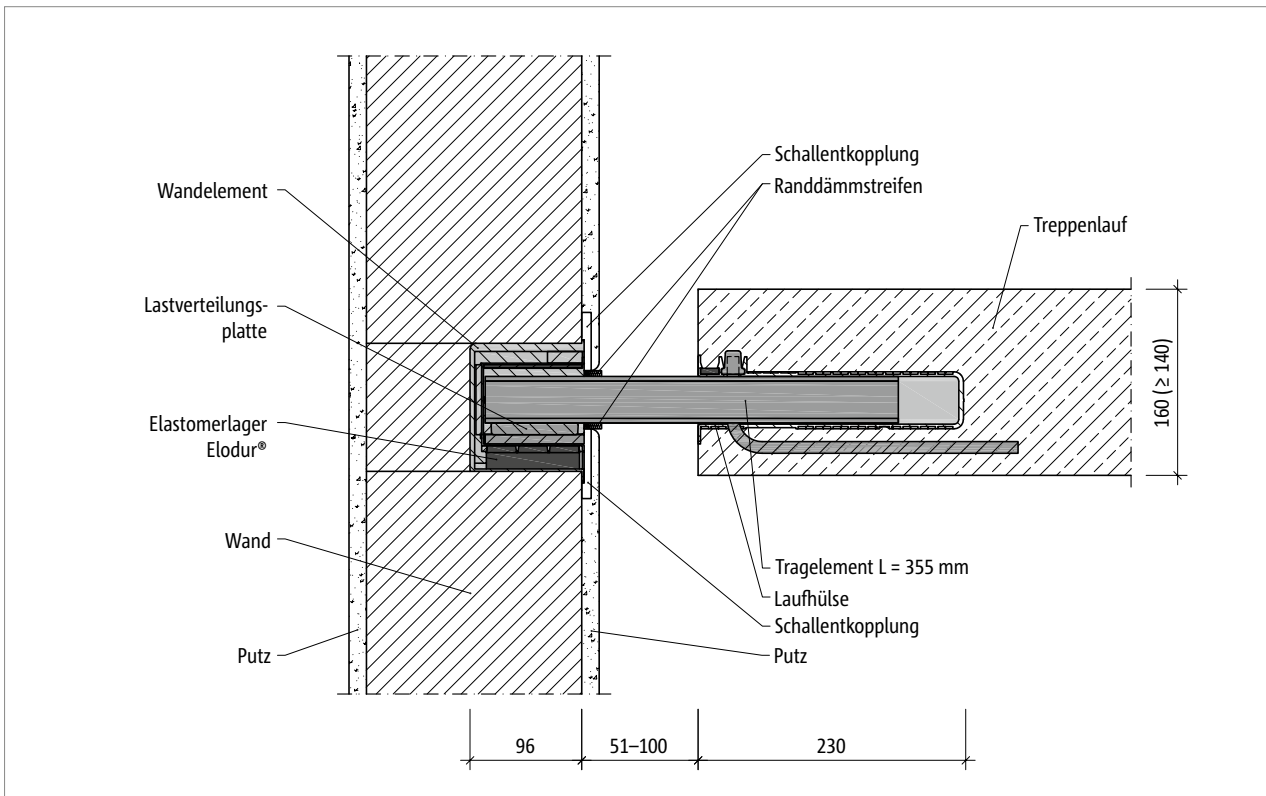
Schöck Tronsole® Typ Q-FV-XL oder Q-A2-XL: Einbauschritt
